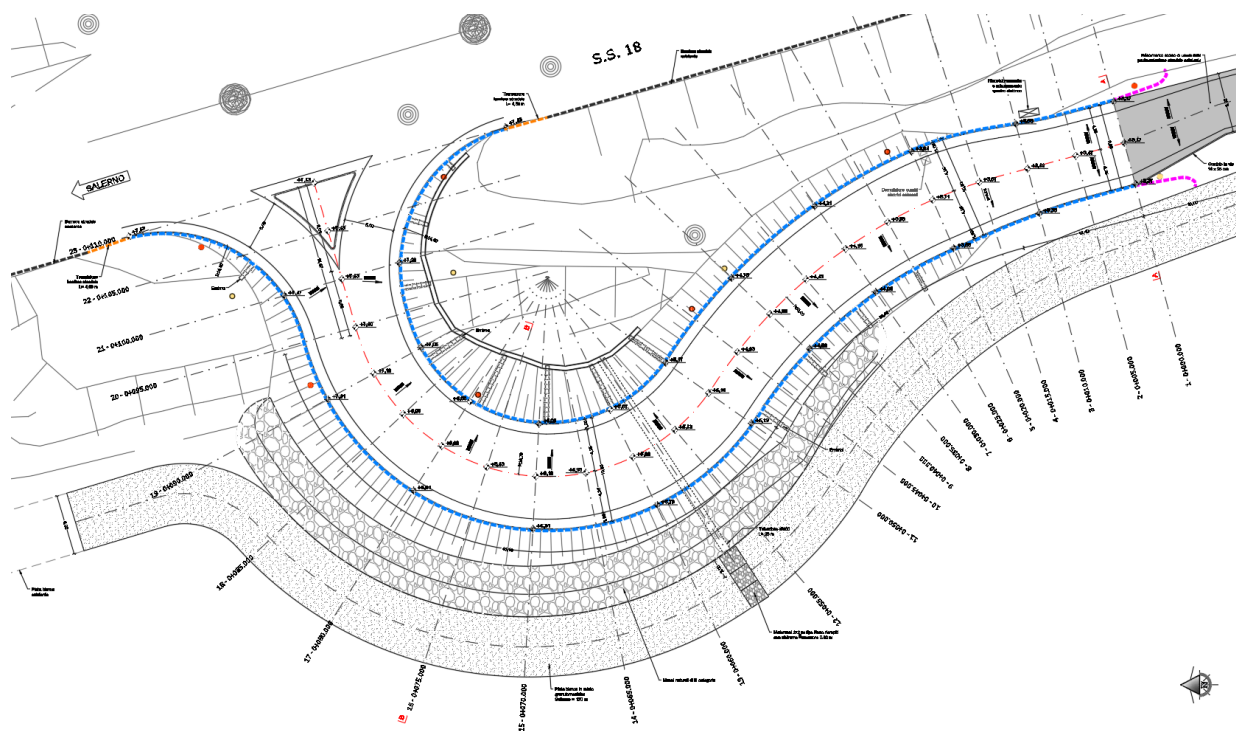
Intervento D - Planimetria raccordo di collegamento porto - SS18
